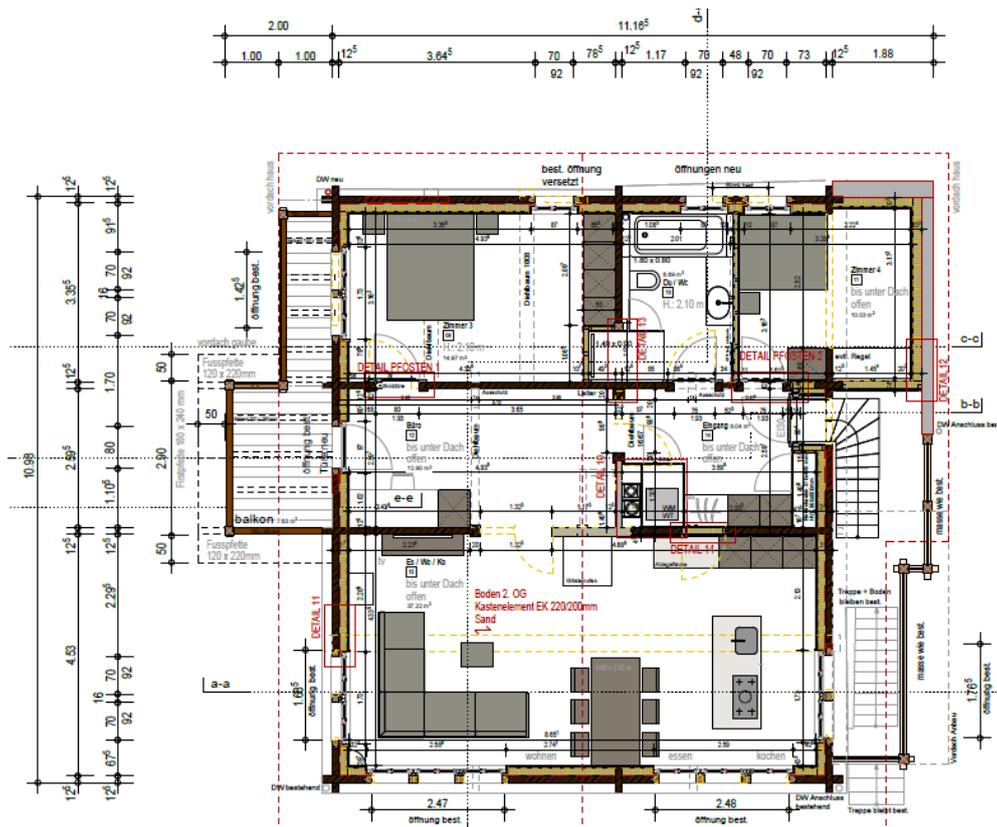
Unmassstäblicher Planausschnitt des Grundrisses 2.OG – Wohneinheit 2
